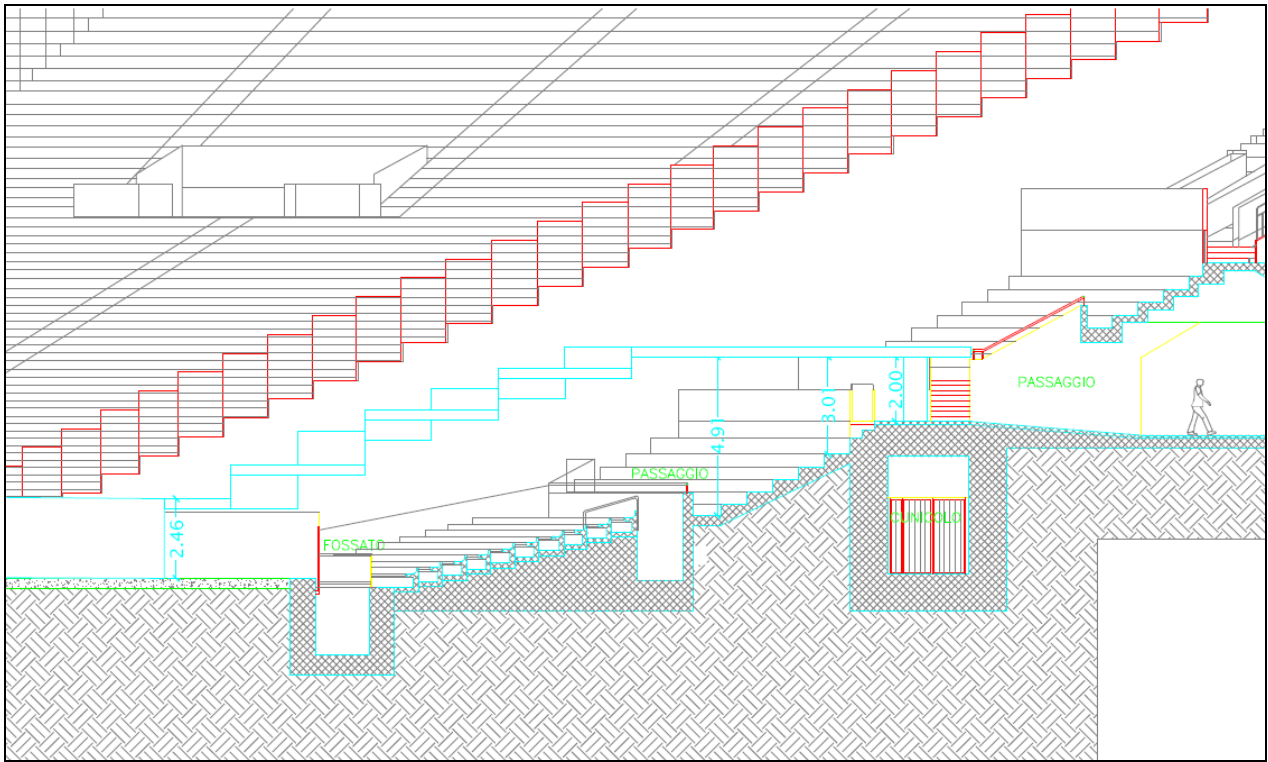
Sezione rampa di servizio presso la Tribuna Tevere
